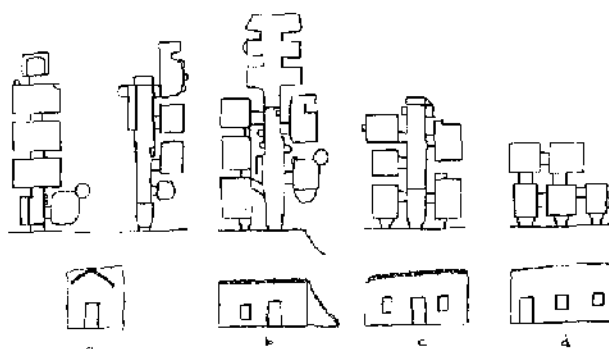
Proceso tipológico de las cuevas viviendas de Alba de Cerrato, teniendo en cuenta sólo la cueva propiamente dicha. a. Cueva oscura, sin más hueco exterior que la puerta de entrada, con dos subtipos: a.1. Planta en escuadra; a.2. Planta en dos ejes paralelos. b. Cueva con planta de tres ejes paralelos en profundidad, pero sólo con dos huecos en la fachada; c. Planta de tres ejes paralelos en profundidad, con fachada de tres huecos dispuestos simétricamente; d. Planta de dos ejes en superficie, y fachada con tres huecos dispuestos de forma asimétrica.
